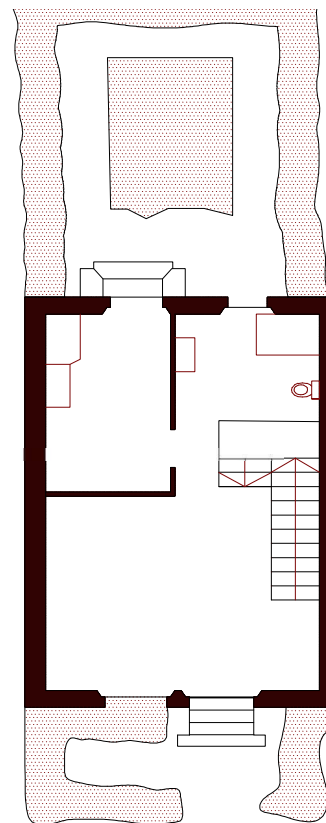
Planta piso térreo habitação extrato alto - CMP
